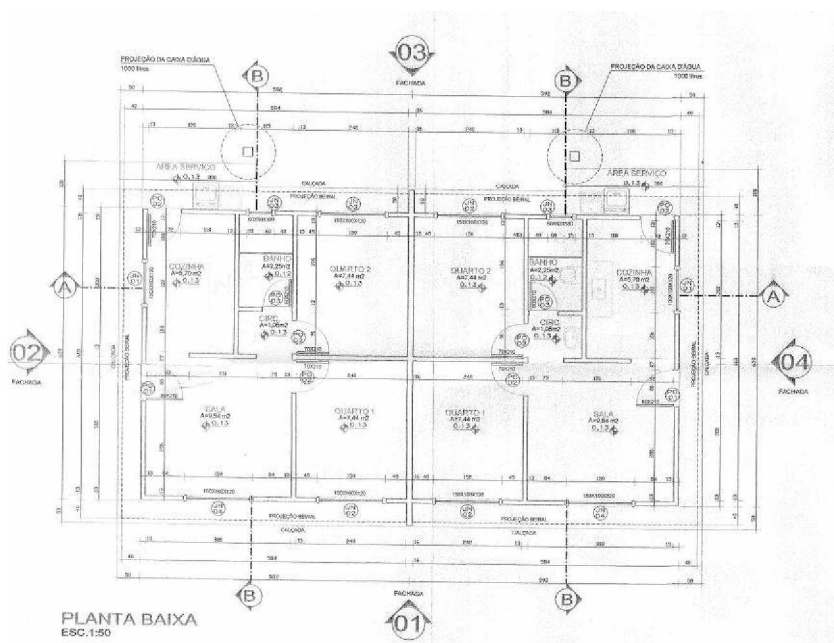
Planta Baixa. Unidade Habitacional.
